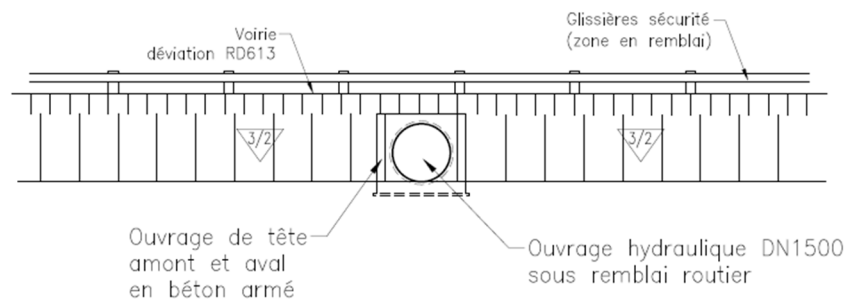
Ouvrages traversants RD613 – Coupe type DN1500
